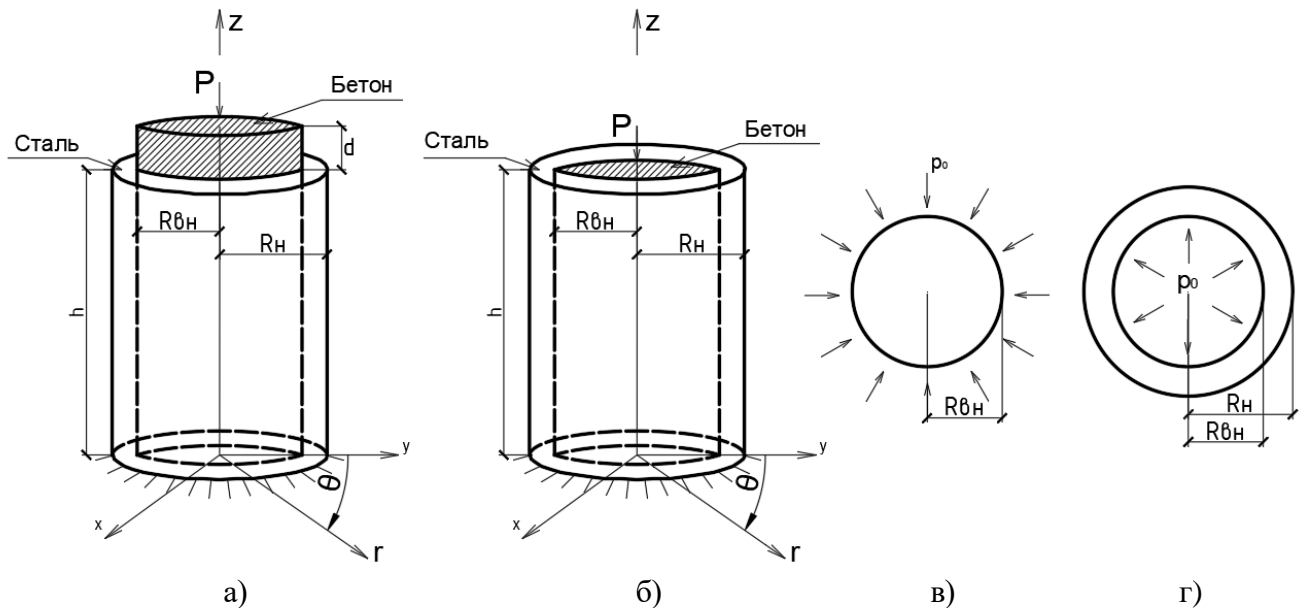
Расчетная схема предварительно напряженной трубобетонной стойки: а) предварительно напряженная трубобетонная стойка на стадии 1 работы; б) предварительно напряженная трубобетонная стойка на стадии 2 работы; в) схема обжата сечения бетонного ядра; г) схема воздействия бетонного ядра на сечение стальной трубы
